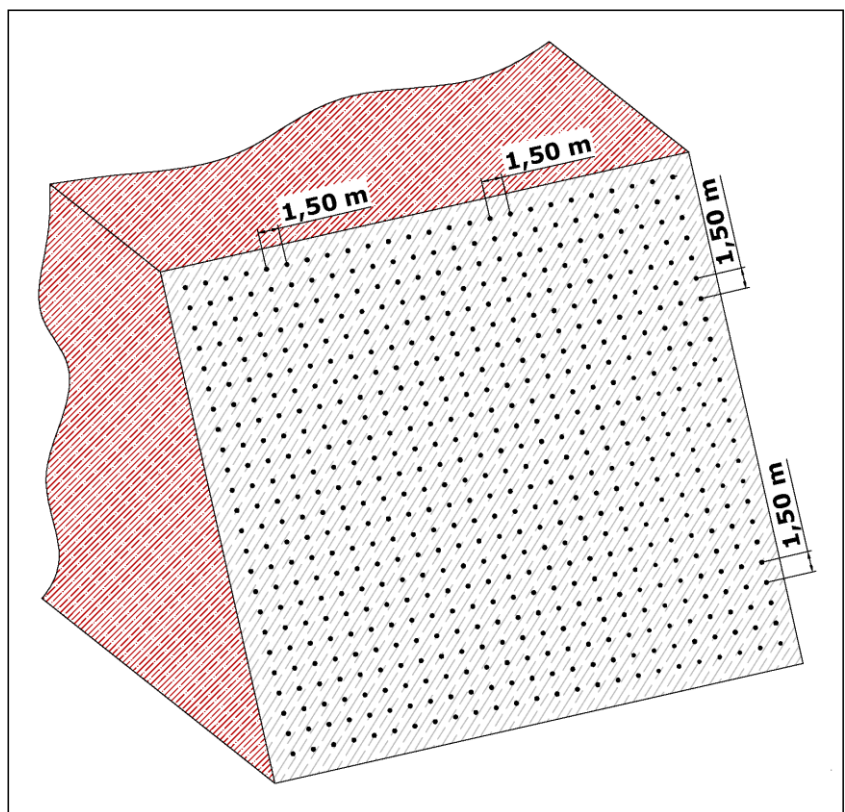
Esboço da vista frontal – disposição dos grampos
